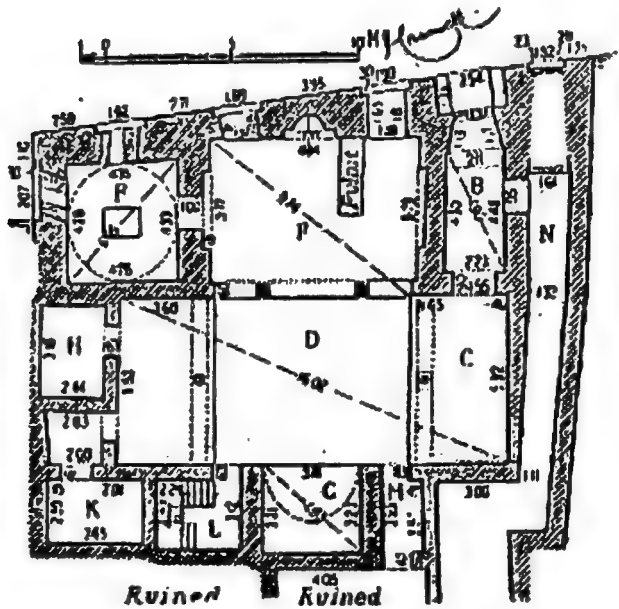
مسقط الأفقي لجامع جاني بك بالقاهرة
